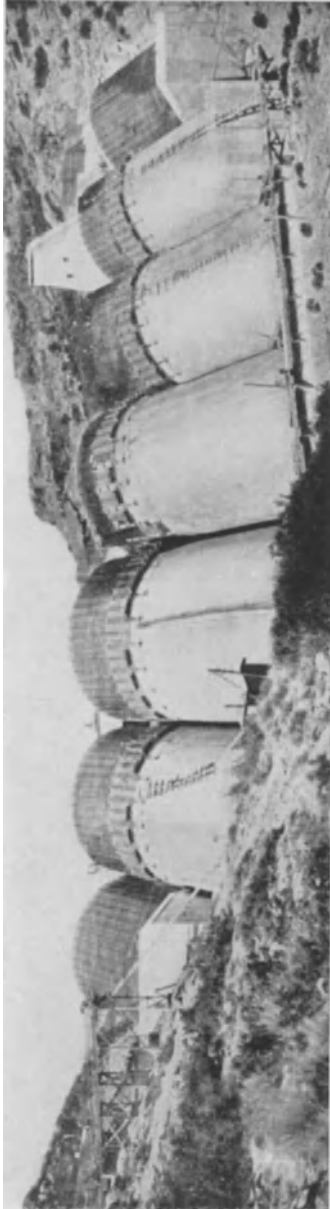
Beni-Bahdel-Pfeilerstaumauer (Marokko). Betoneinbringung durch Förderpumpen.
